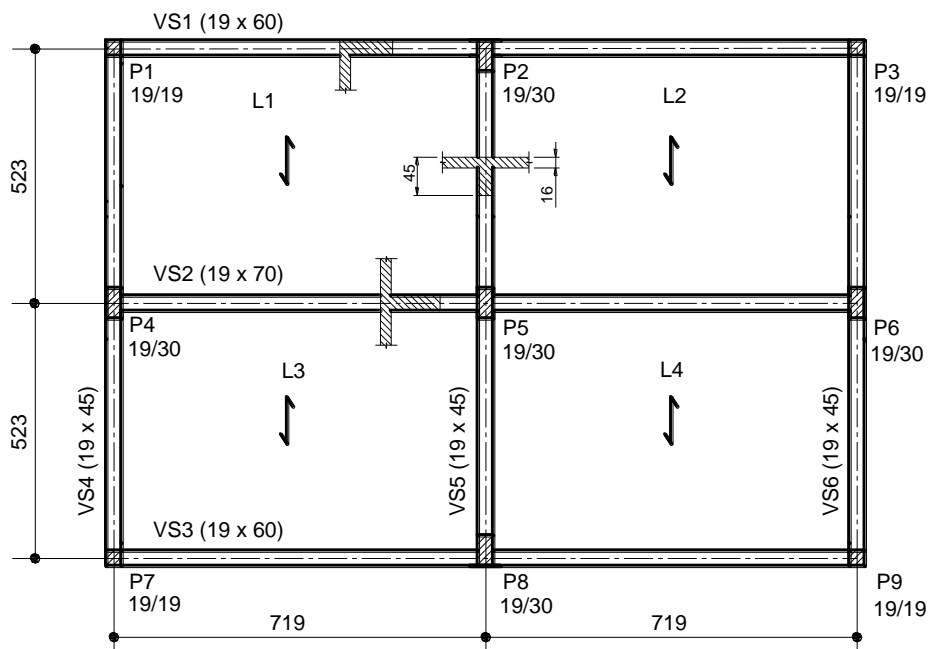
Planta de fôrma do sistema estrutural tradicional (lajes, vigas e pilares).
